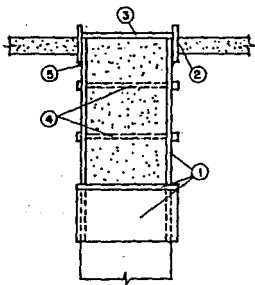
Encamisado metálico de una unión viga-columna (Ref. 15)
